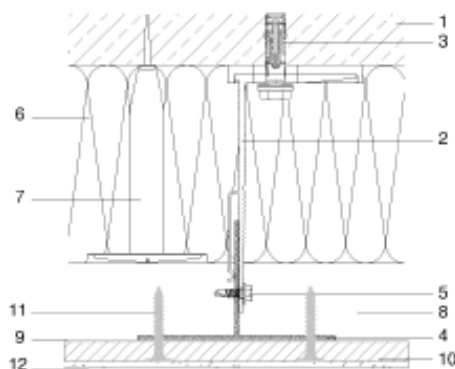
Detalhe construtivo de corte horizontal do sistema [78].
